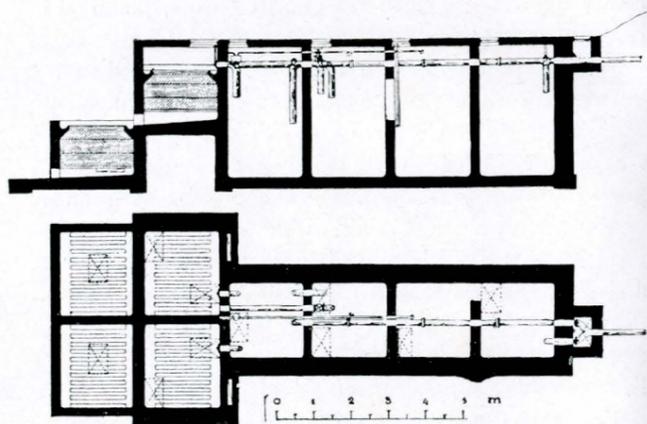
Pianta e sezione dell'impianto di depur. biologica.
